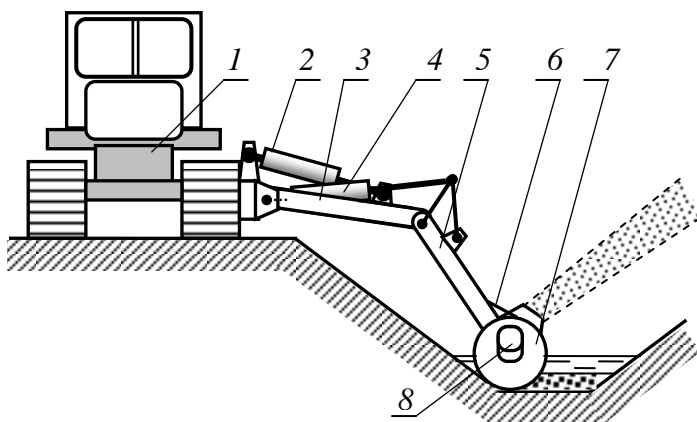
Схема работы каналочистителя с фрезерным рабочим органом.
